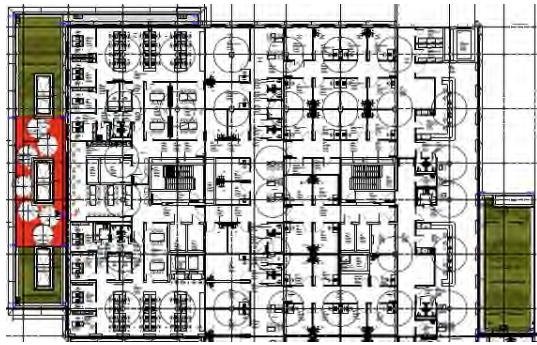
Intensive Dachbegrünung Dach 5.OG (Quelle: Topotek 1)
